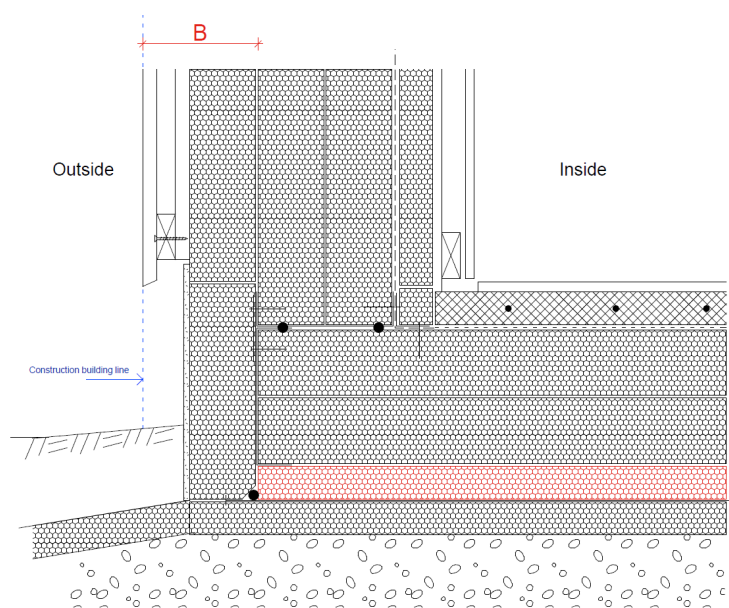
montering av andra lagret av FOAMGLAS® FLOORBOARD isolering "B" mm från byggnadens färdiga utsida.
